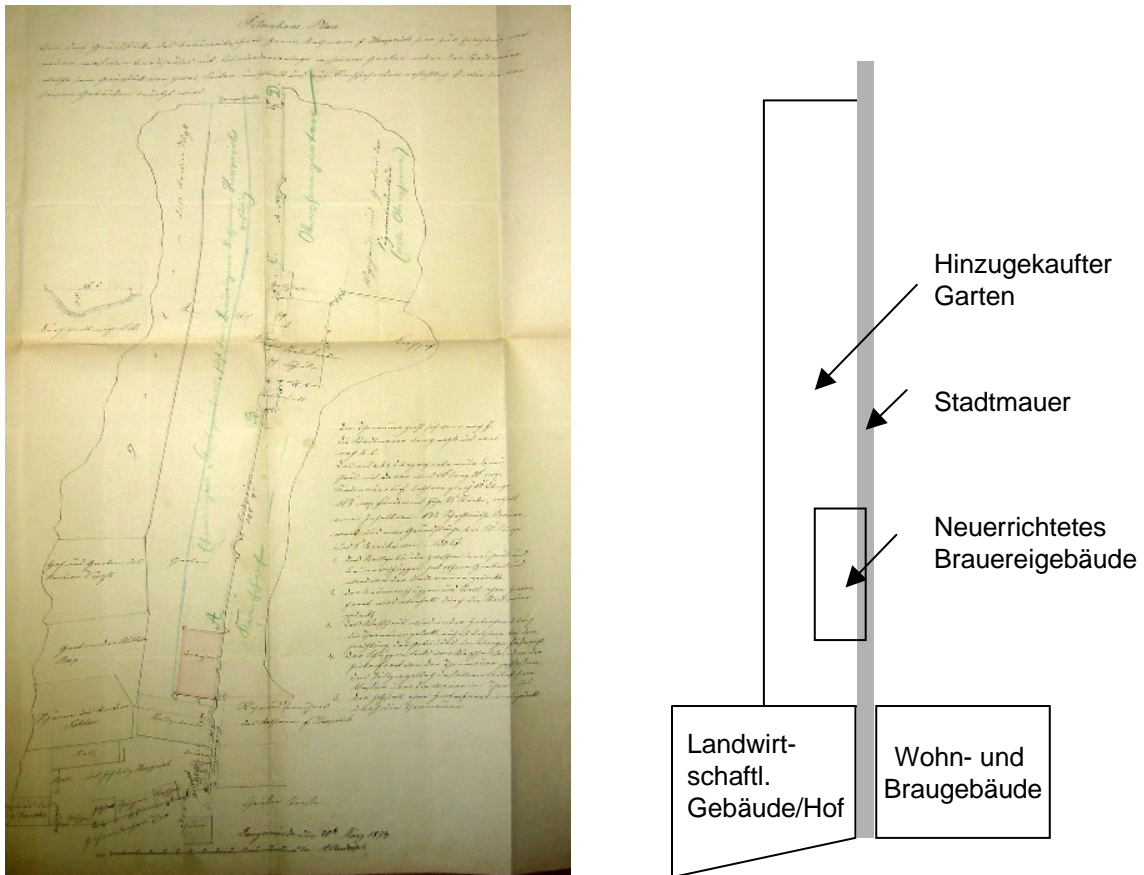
Lageplan des Brauereigrundstückes von 1874 incl. neu errichtetem Brauereigebäude im Hinterhof
